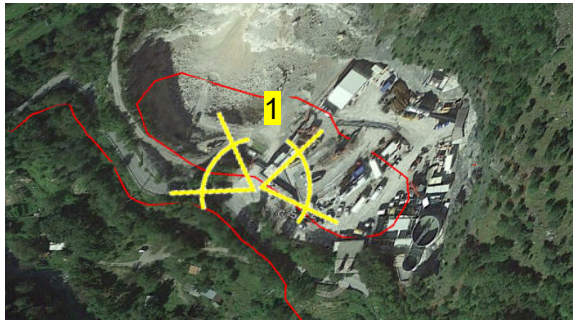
Punto di vista 3°C- Ingresso cantiere CBL3
